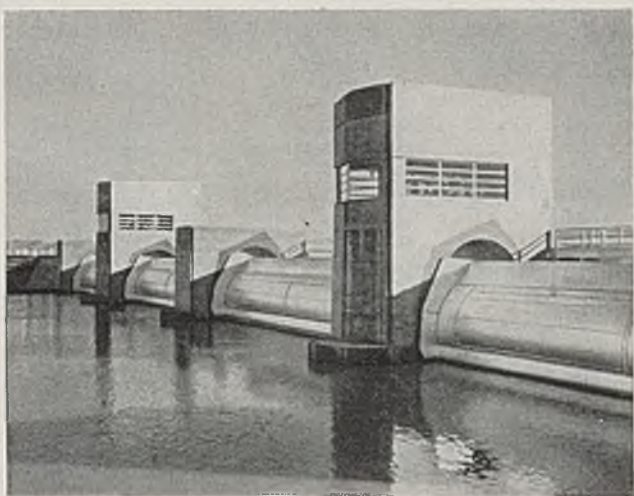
Imperial-Stauanlage. Walzenwehre zur Regelung der Zuführung zu den Absitzbecken.
